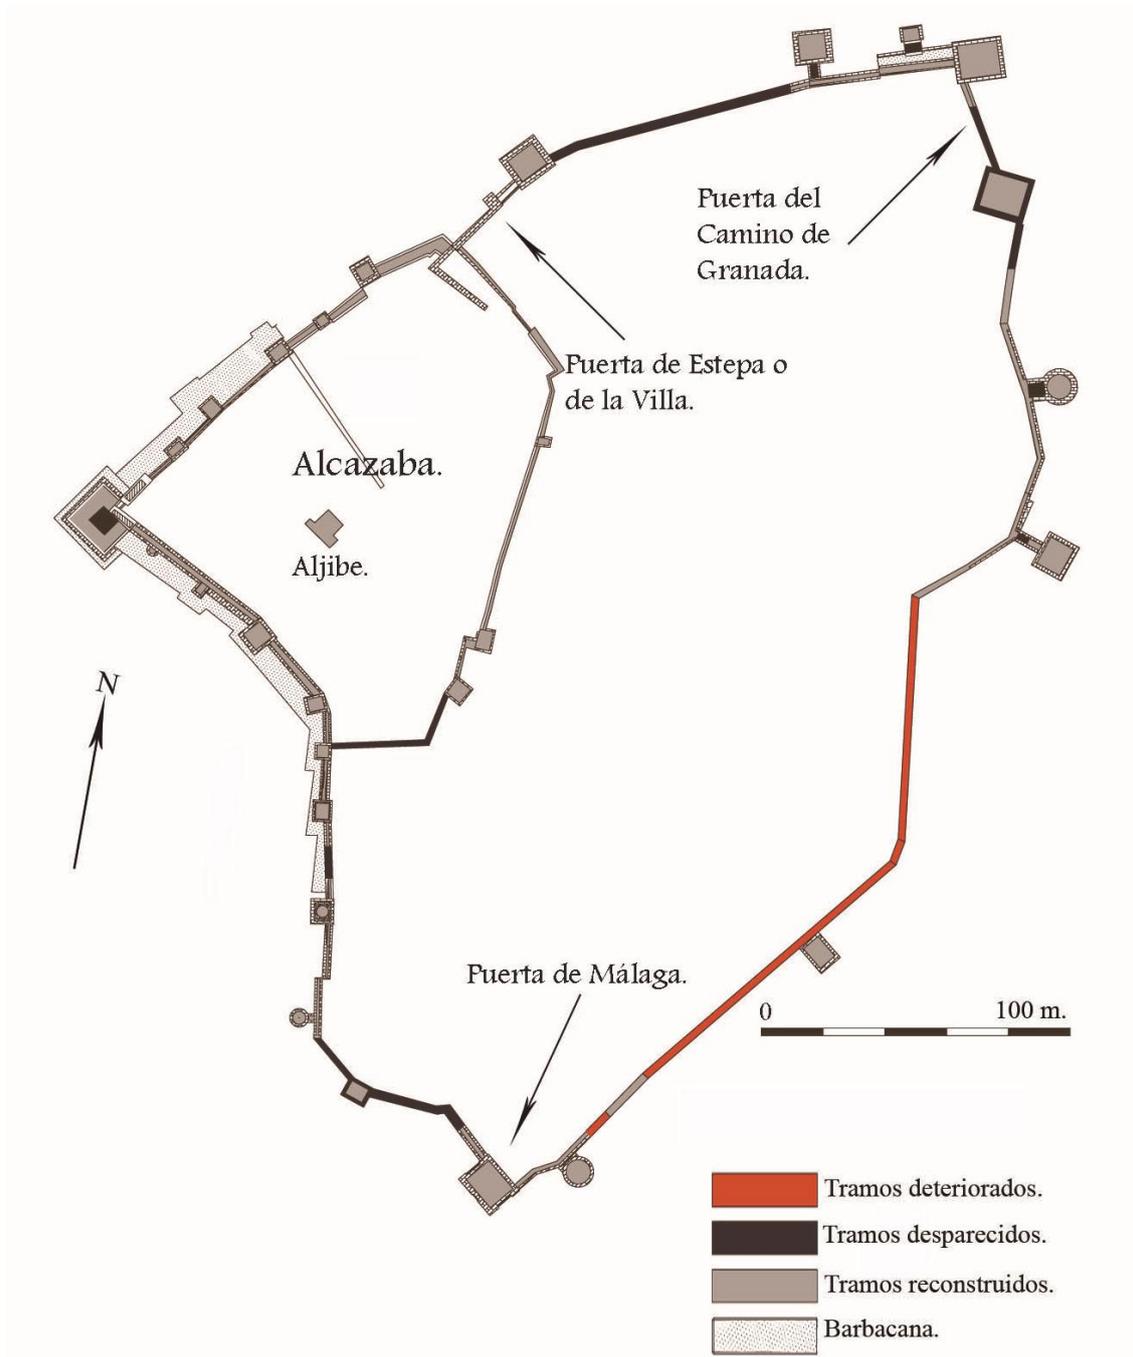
Planta general de las murallas de Antequera. Situación de las puertas del recinto murado. (Fuente: Romero. 2002).
